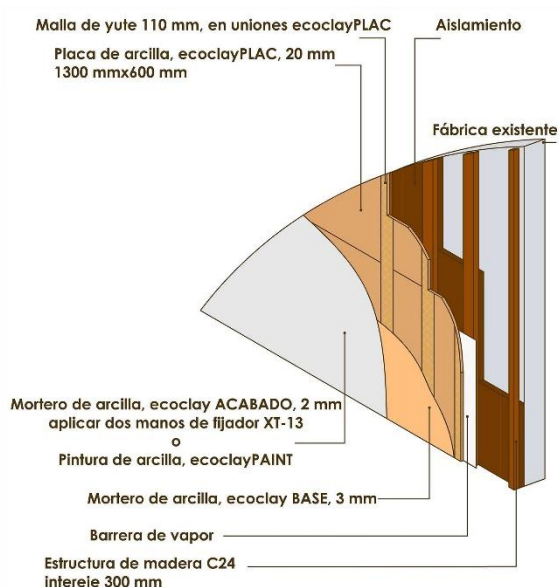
Sistema constructivo con placas de arcilla Fuente: <https://ecoclay.es/>
